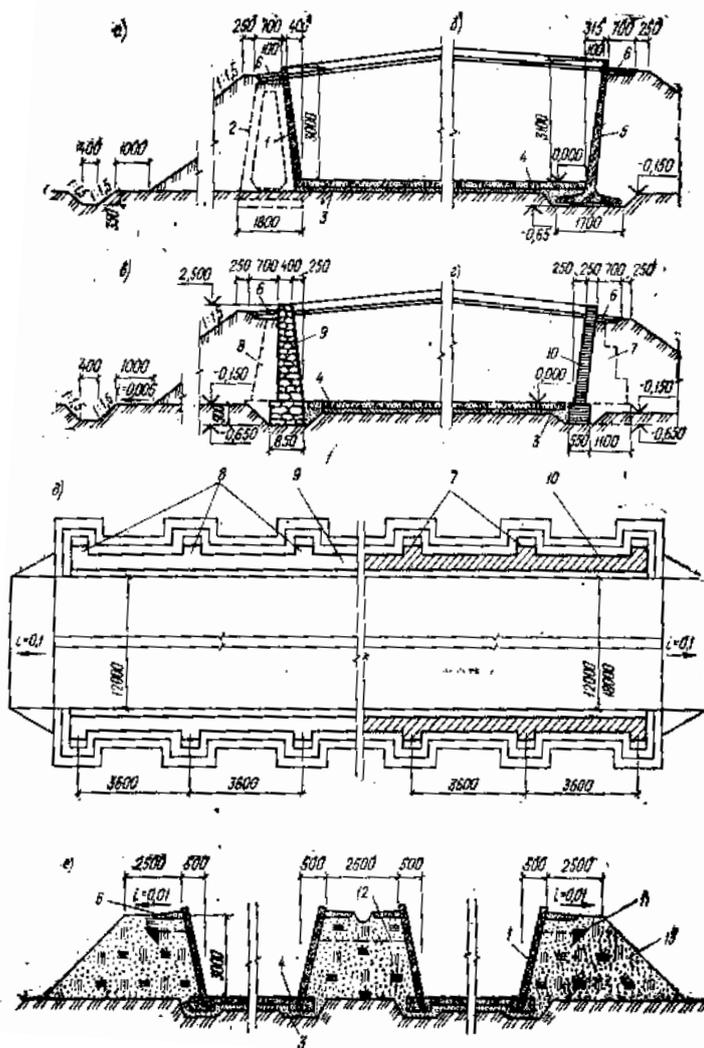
Конструкции наземных силосных (сенажных) траншей
